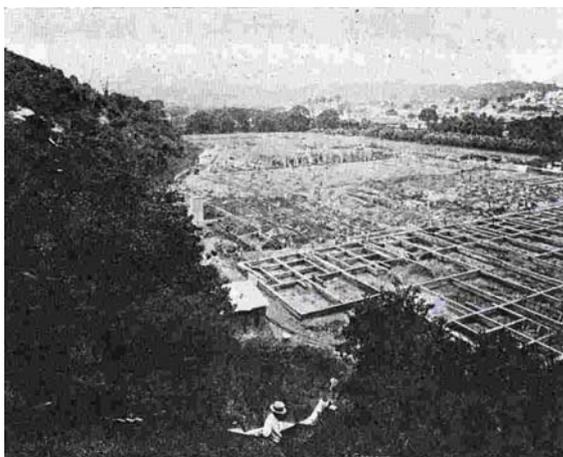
Construcción de la Urb. San Agustín del Sur. 1928.
